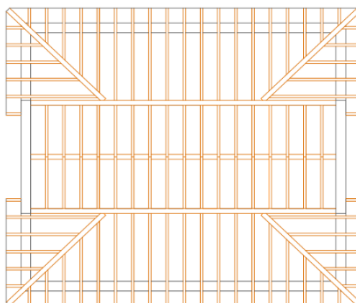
Planta de estructura de Cubierta. Fuente: CAD Propia
